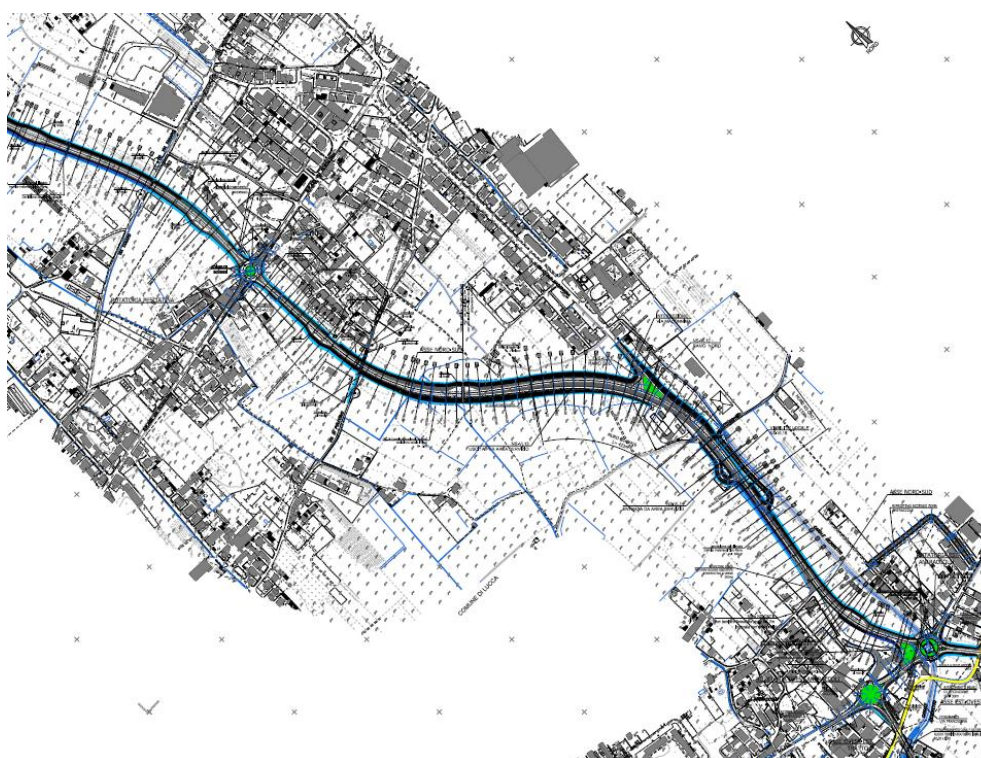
Asse Nord-Sud – Planimetria di progetto stralcio 3/3
